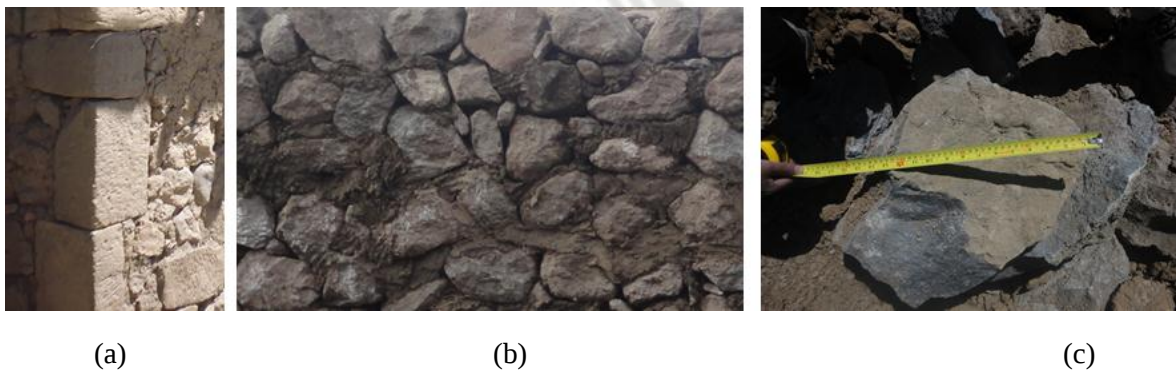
(a) Piedra tallada para esquinas y marcos, (b) Piedras para muro y (c) Piedras para cimentación
